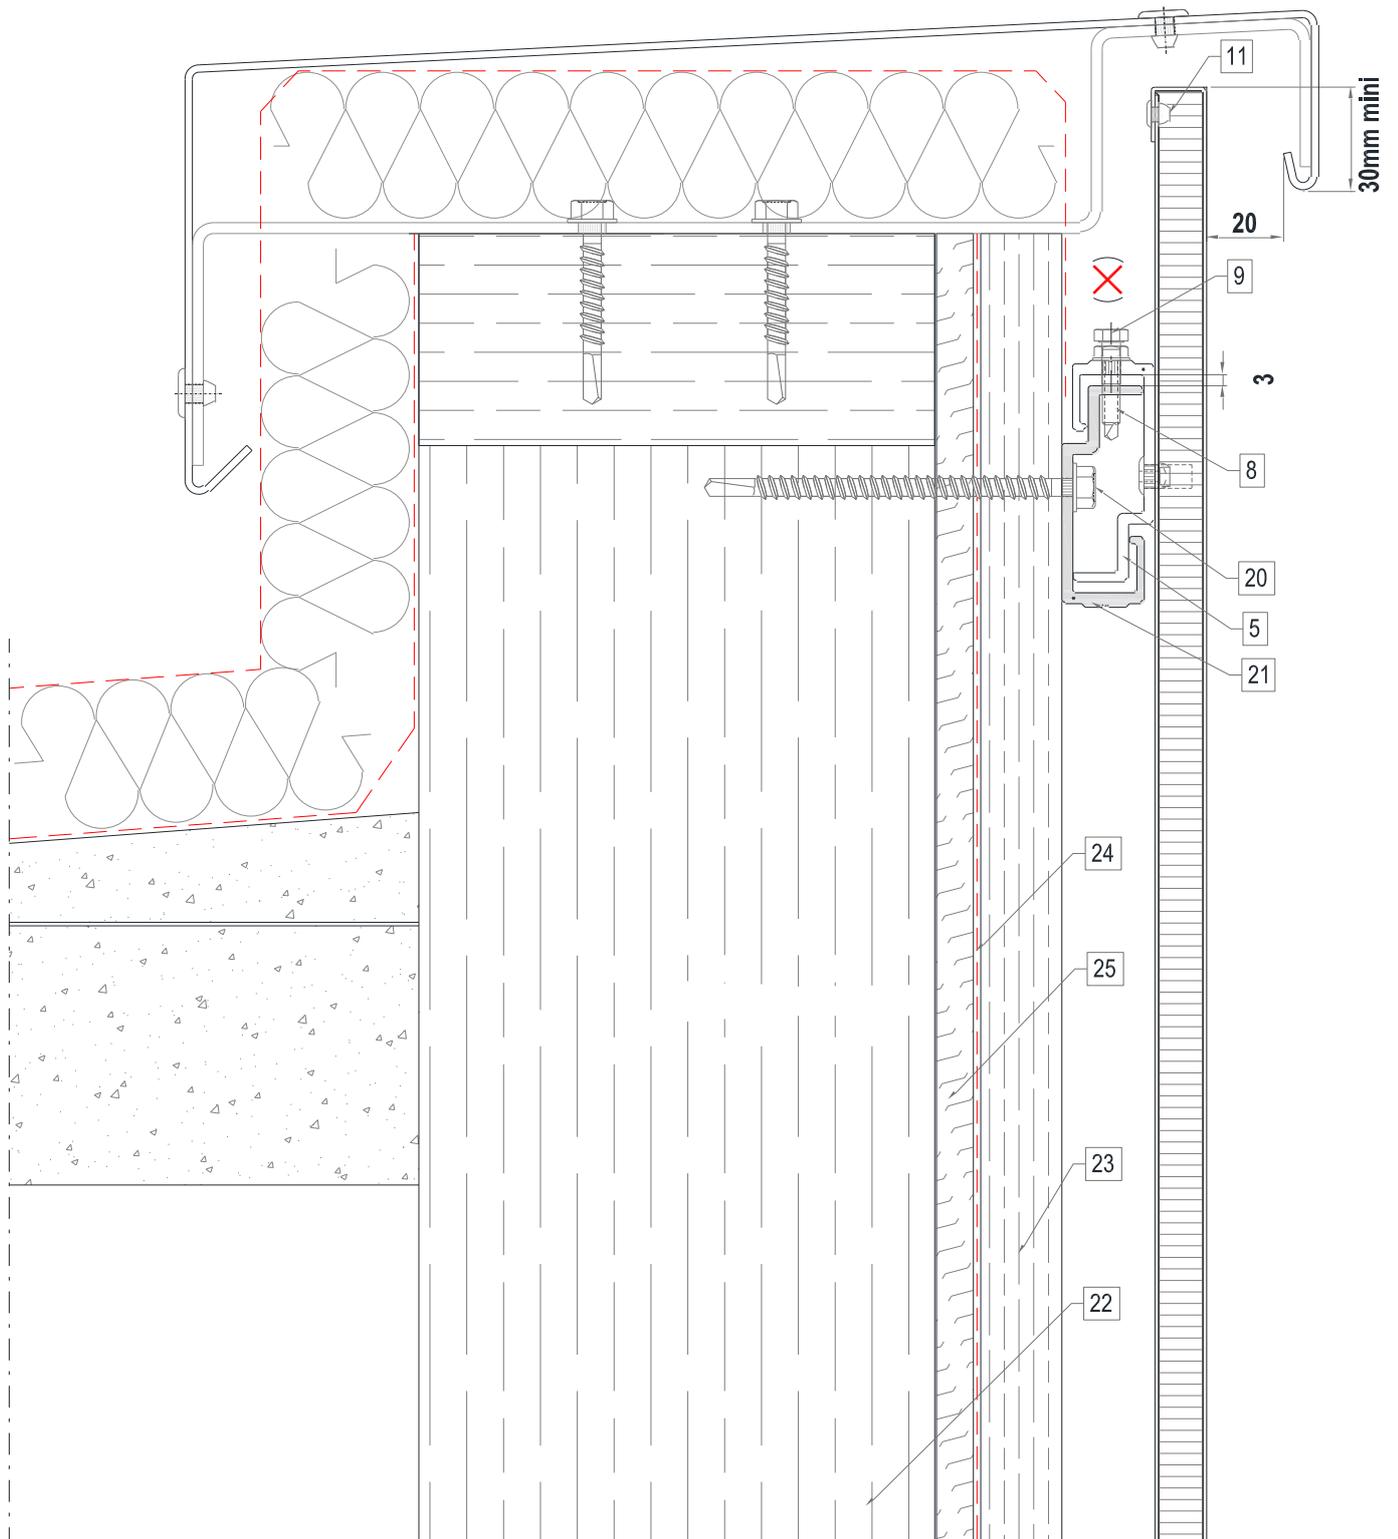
Fractionnement du panneau au droit de chaque plancher – Coupe verticale sur COB
